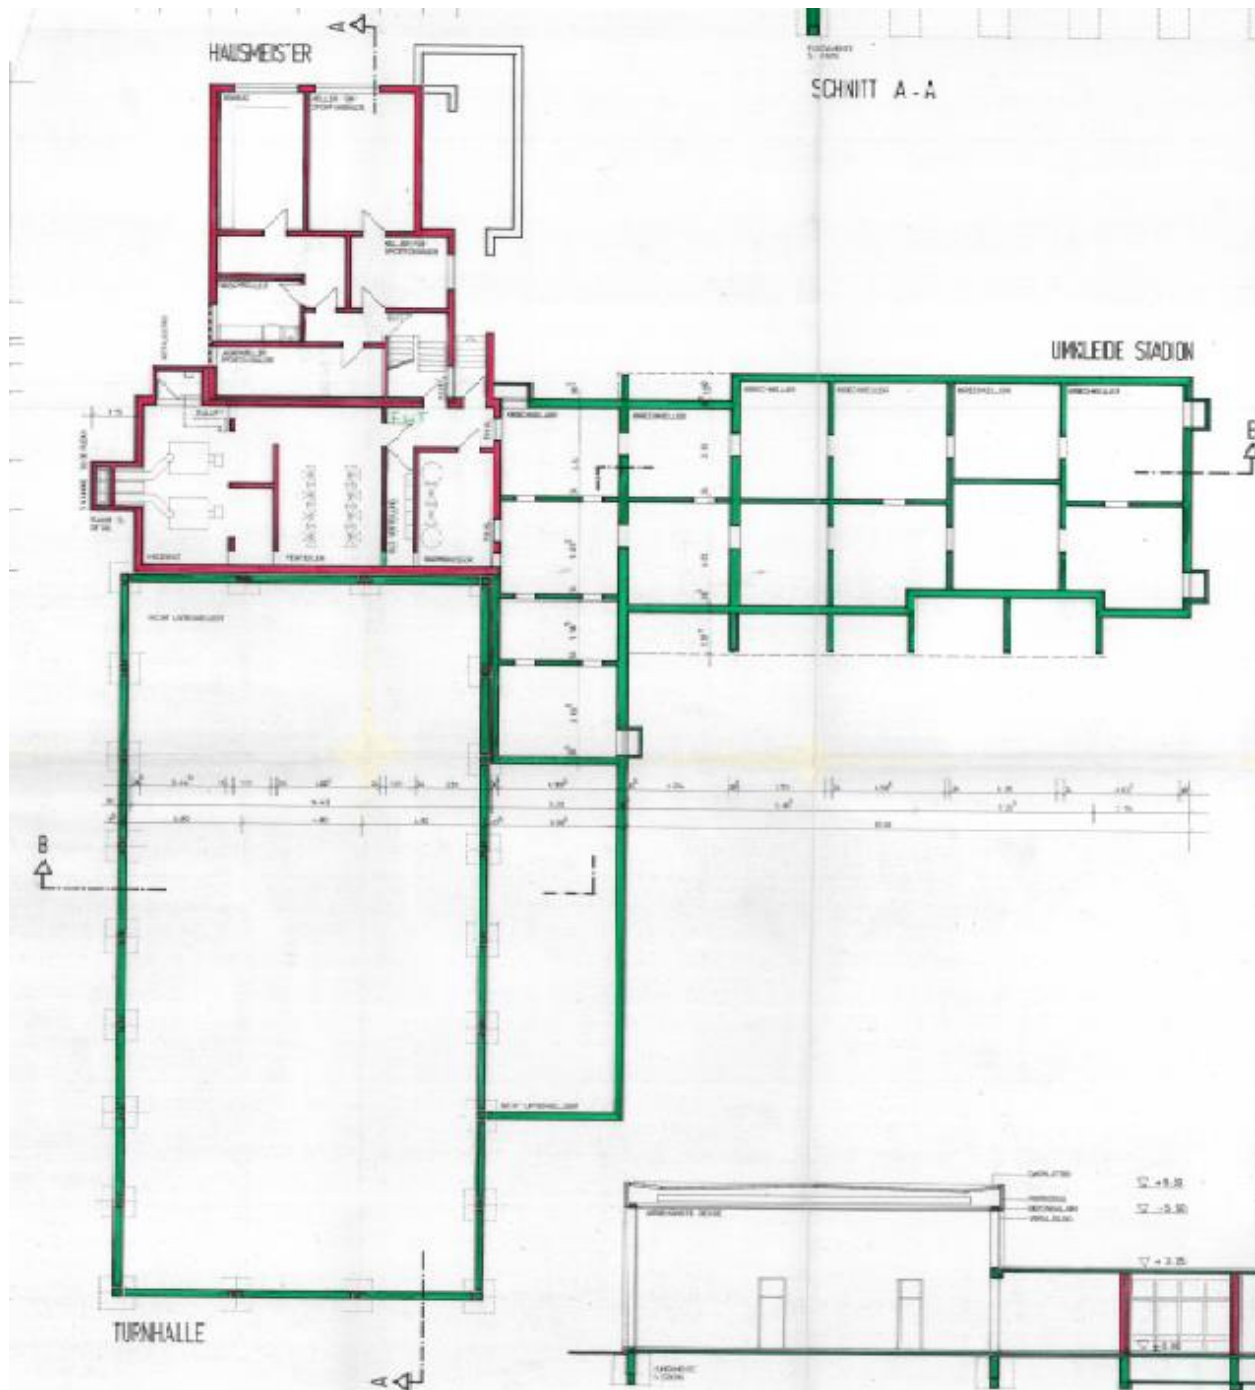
Grundriss Kellergeschoss im Bestand [U6.1]
